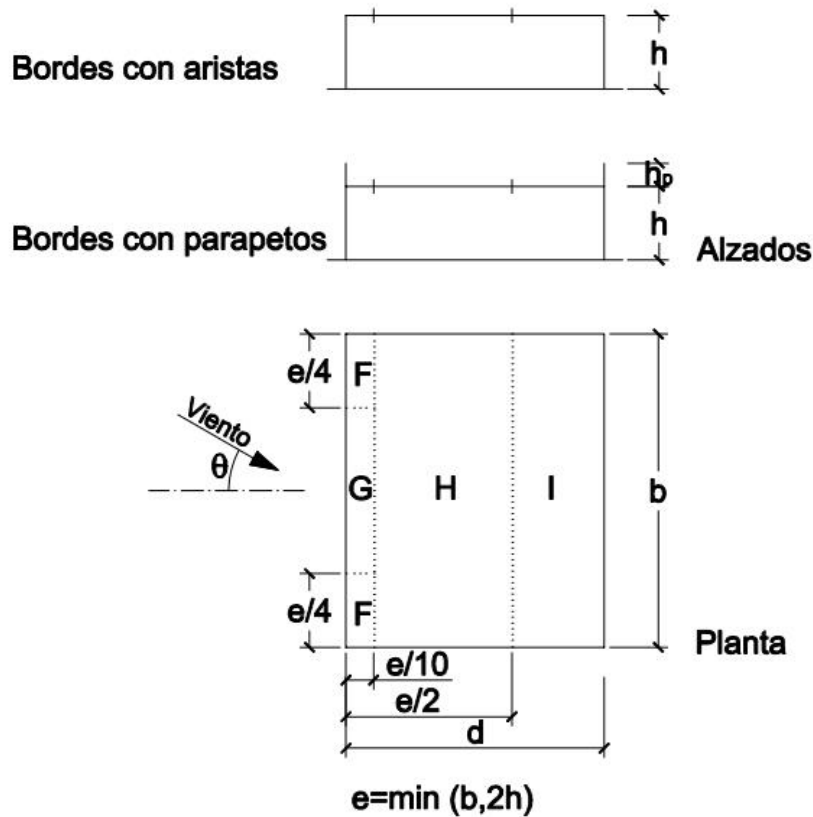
Alzado y planta en cubierta plana. (Tabla D.4 – CTE-DB-SE-AE)
